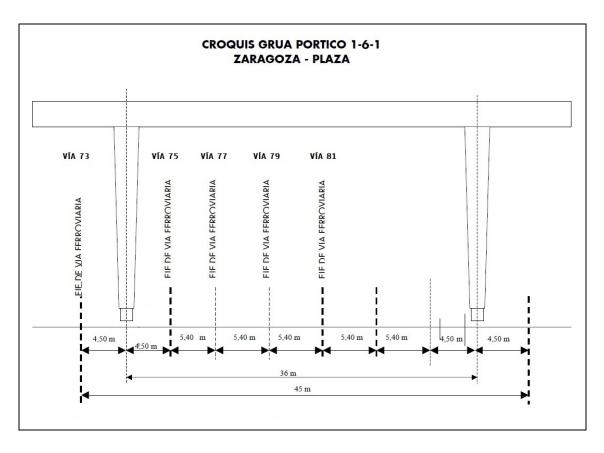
Croquis grúa pórtico 1-6-1 C.L. Zaragoza Plaza
